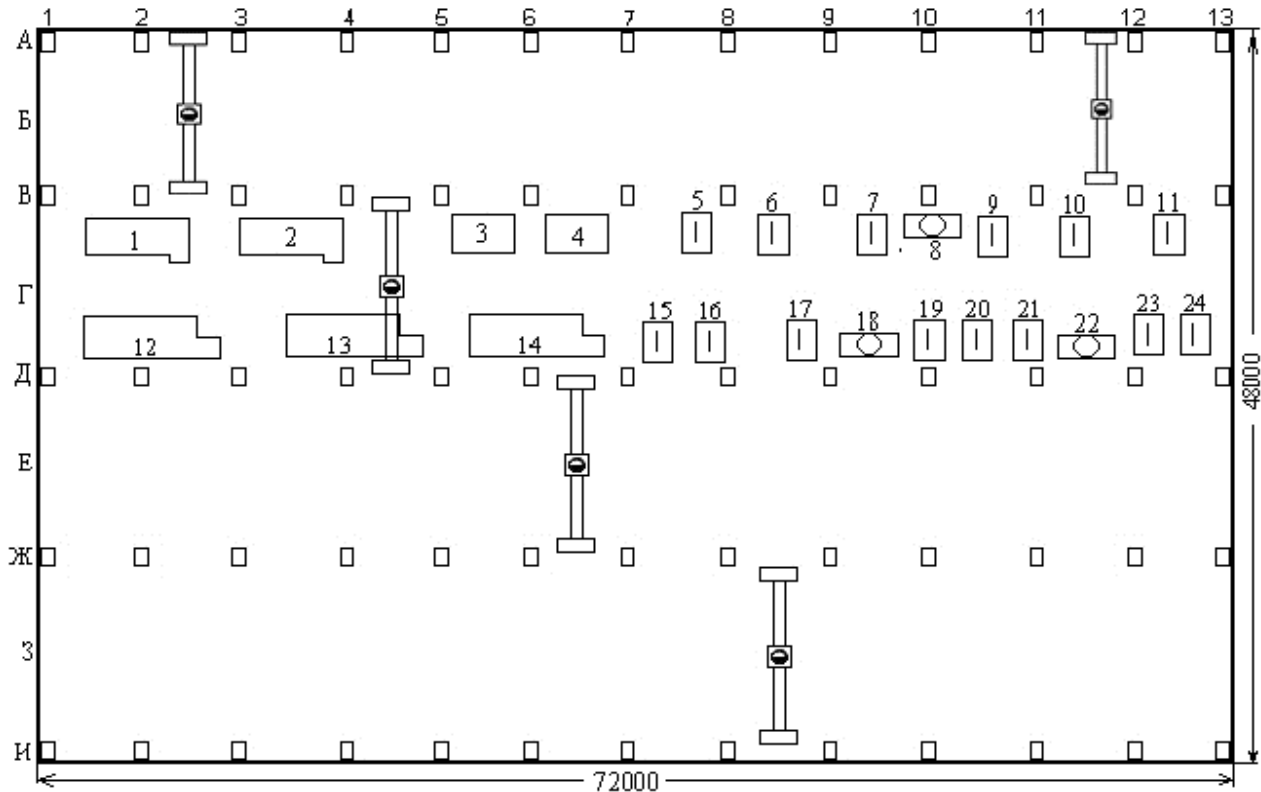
Схематичний план нафтонасосного цеху.
